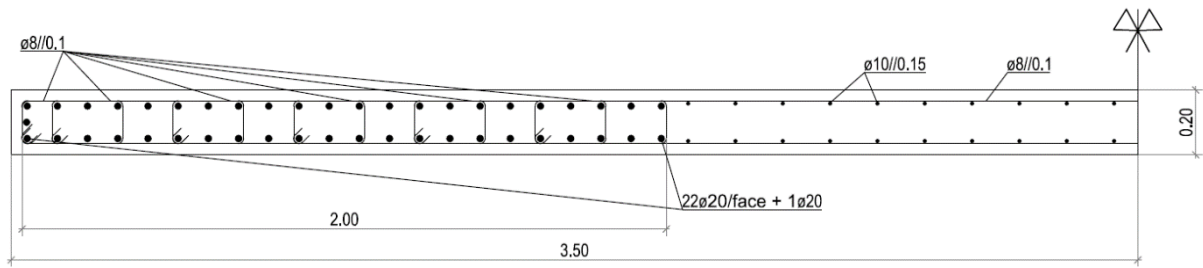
Armadura longitudinal e transversal para as paredes Pa5 e Pa6 para o nível 1
